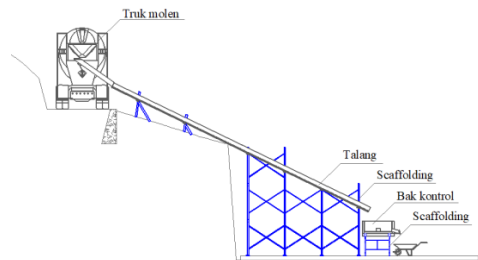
Pekerjaan pengecoran ring balok dan plat lantai
